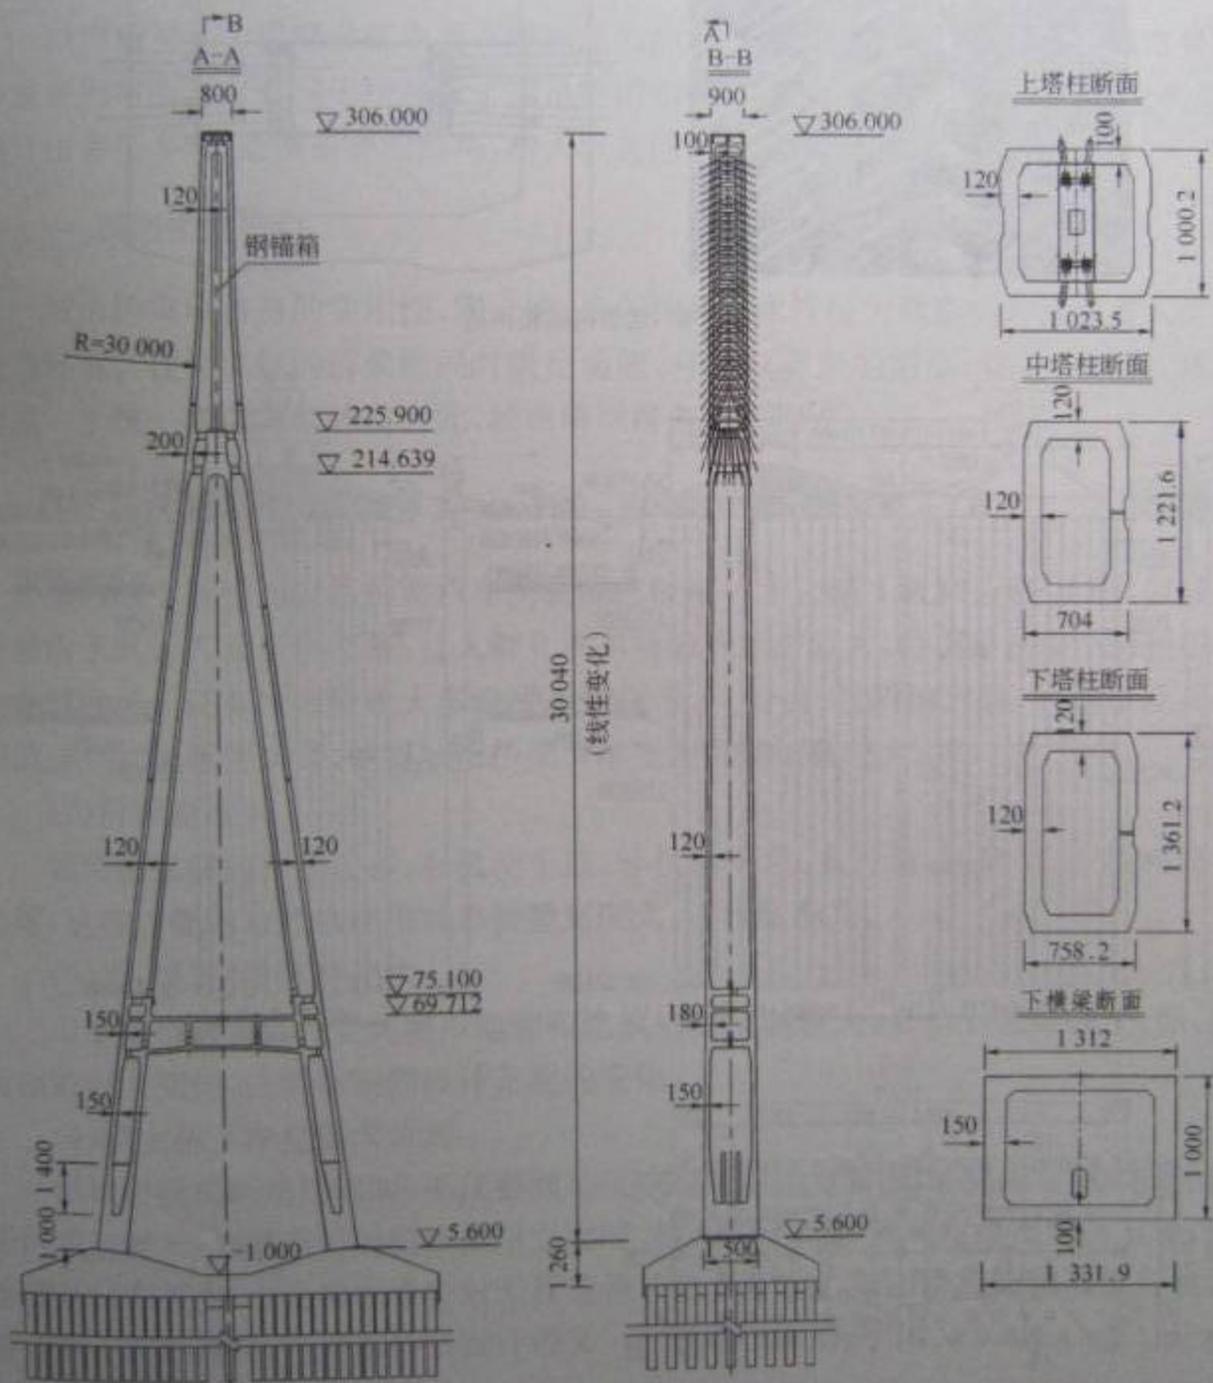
索塔一般构造(尺寸单位:高程:m,其他:cm)
